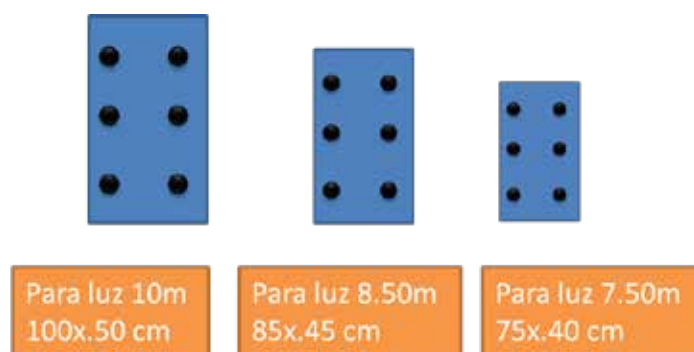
Pre dimensionado de vigas de concreto armado. Fuente: Violeta Monsalve 2020
